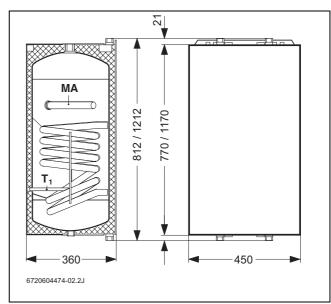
Maßangaben hinter einem Schrägstrich beziehen sich auf die nächstgrößere Speicherausführung.
